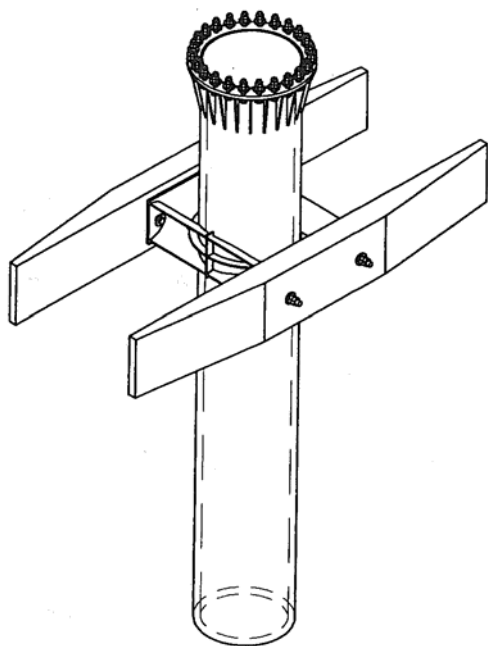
Фундамент из сваи-оболочки, усиленный двумя ригелями.
